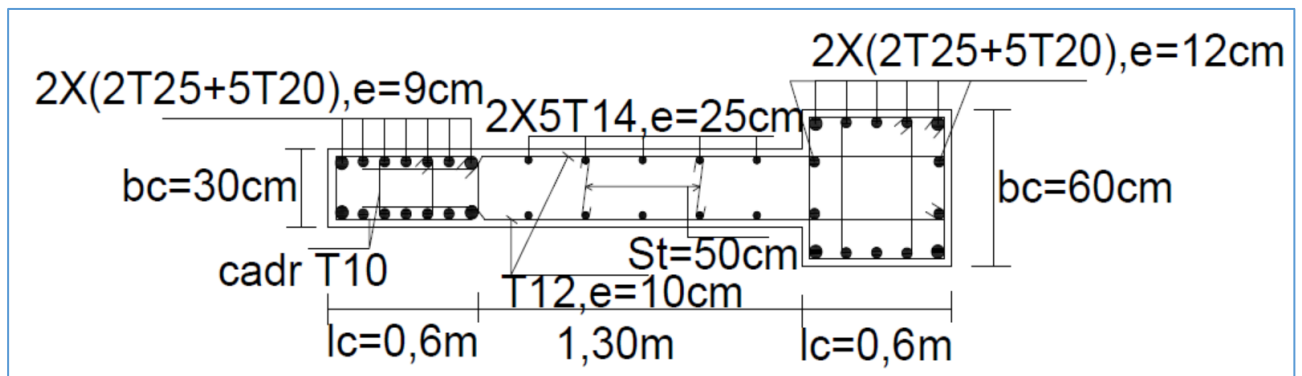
La coupe de ferrailage des voile sens x épaisseur 30cm.
